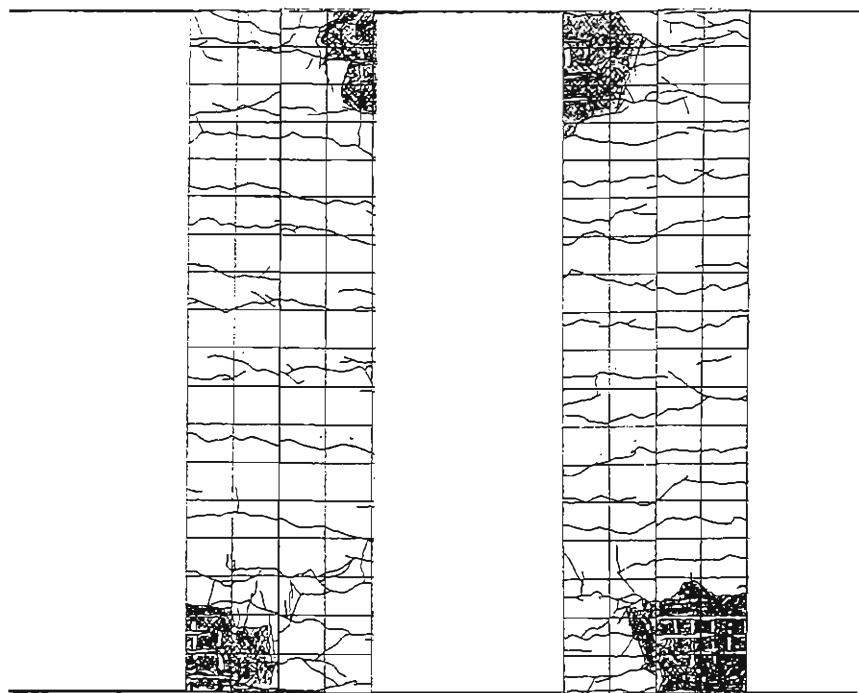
桁体のひび割れ状況展開図（ケース2、9 δy）
